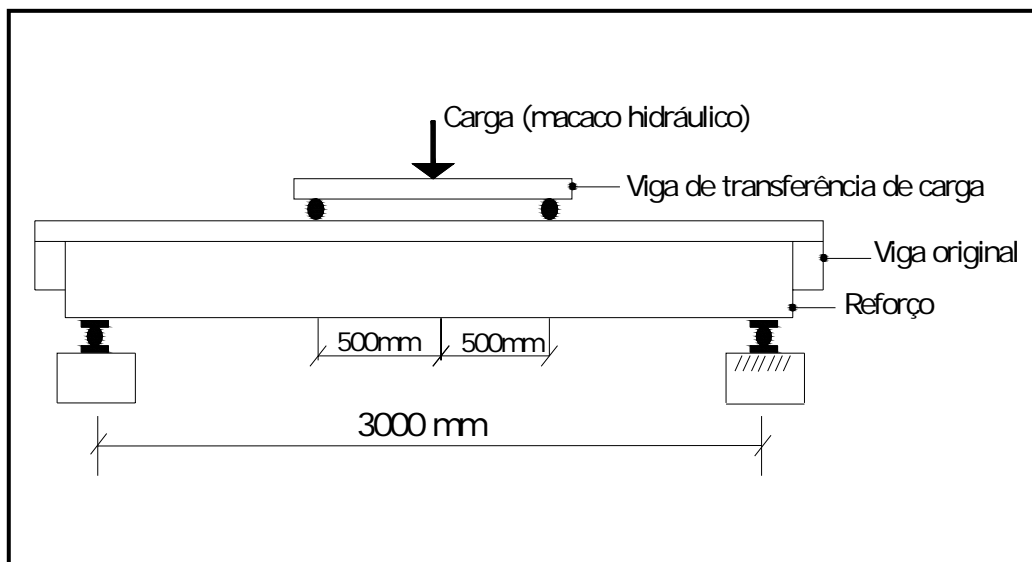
Esquema de carregamento das vigas simplesmente apoiadas de CHEONG e MACALEVEY (2000).
